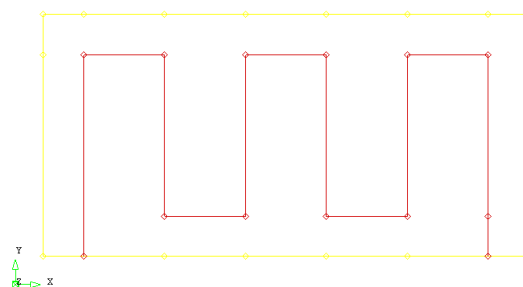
Planta do Modelo Tridimensional do Bloco de Betão com serpentinas
